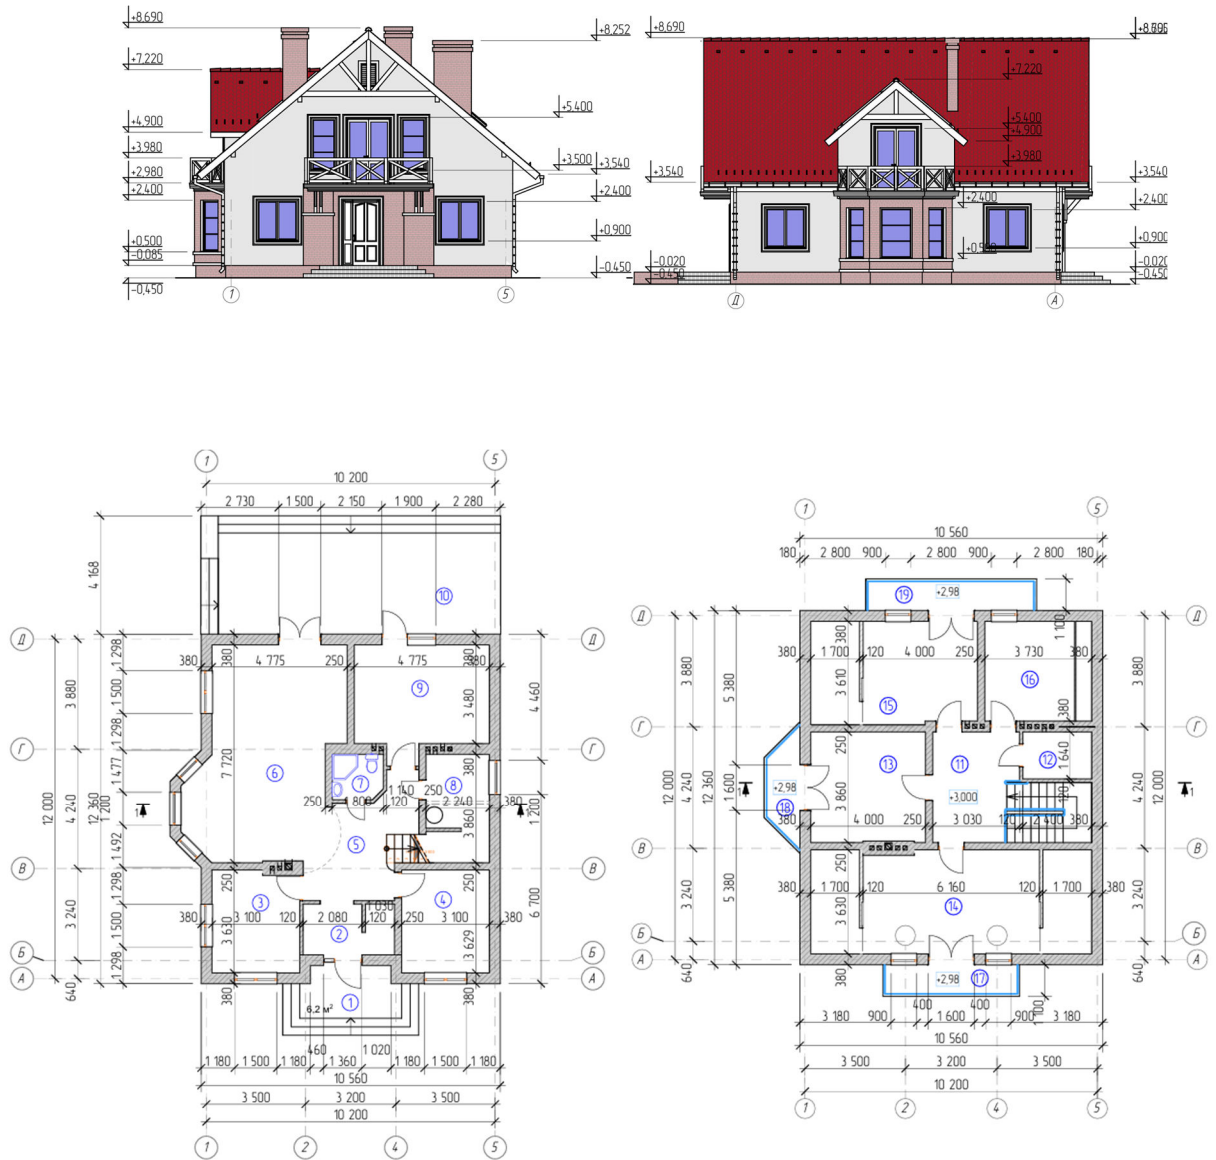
Тип 1. Одноповерховий житловий будинок з мансардним поверхом. Фасади. План першого та мансардного поверху
